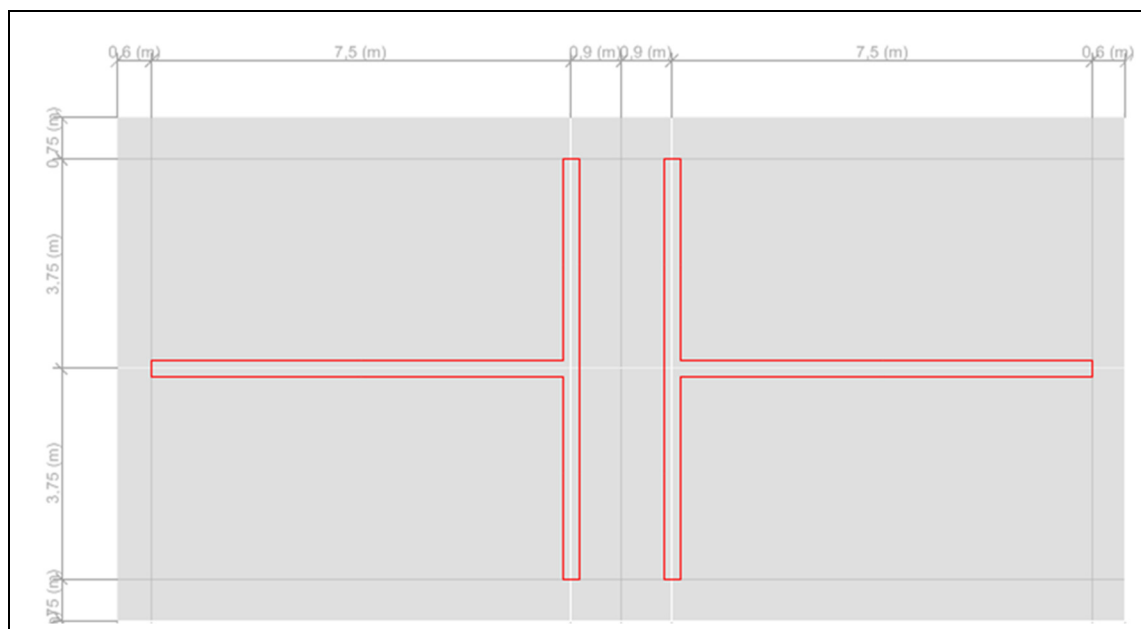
Zoom planta del edificio de estudio con muros T.
